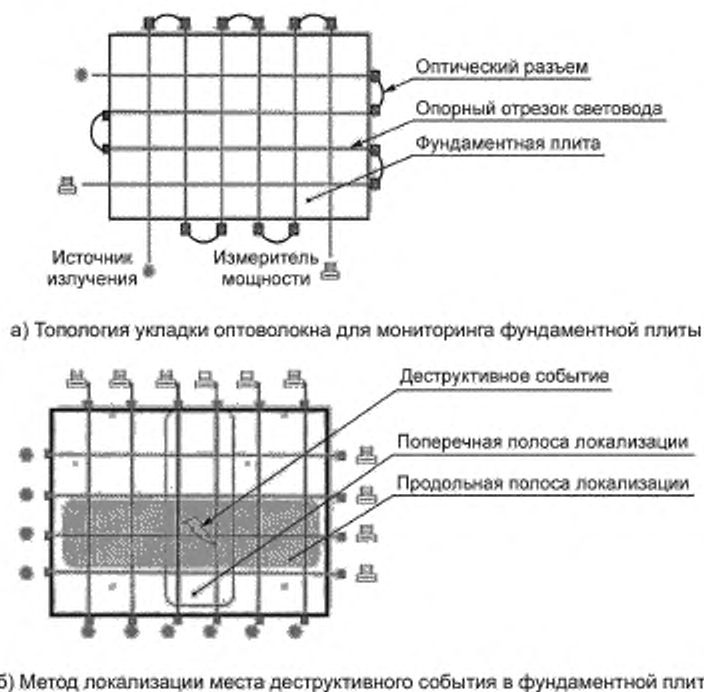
Пример мониторинга деформаций в фундаментной плите с использованием оптоволокну
